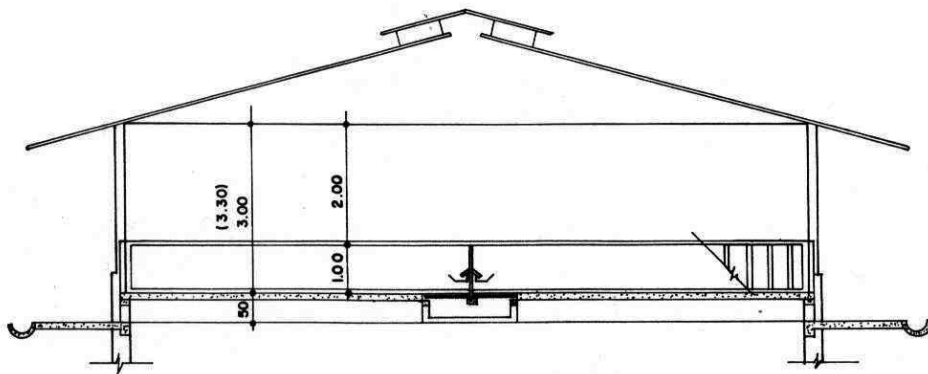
Corte lateral da instalação com sistema piso concretado.
